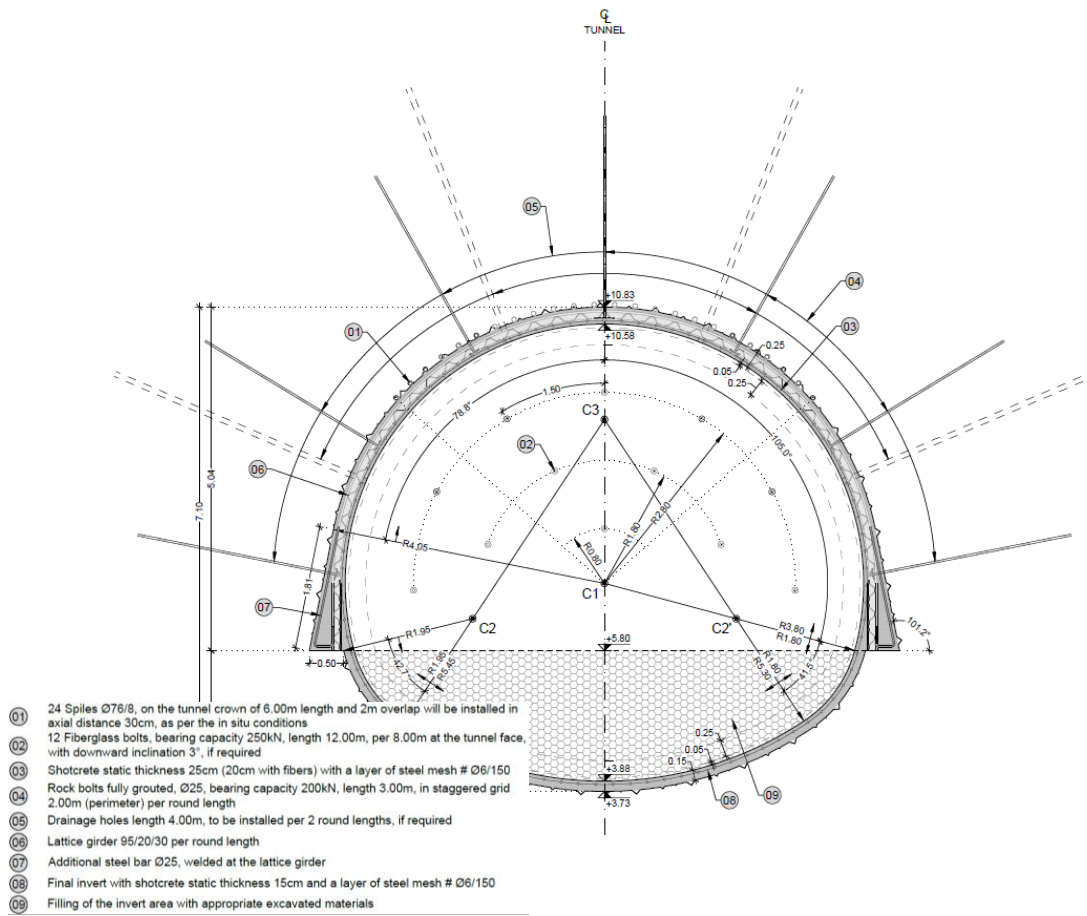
Escavação e Apoio Inicial do Túnel de Acesso
